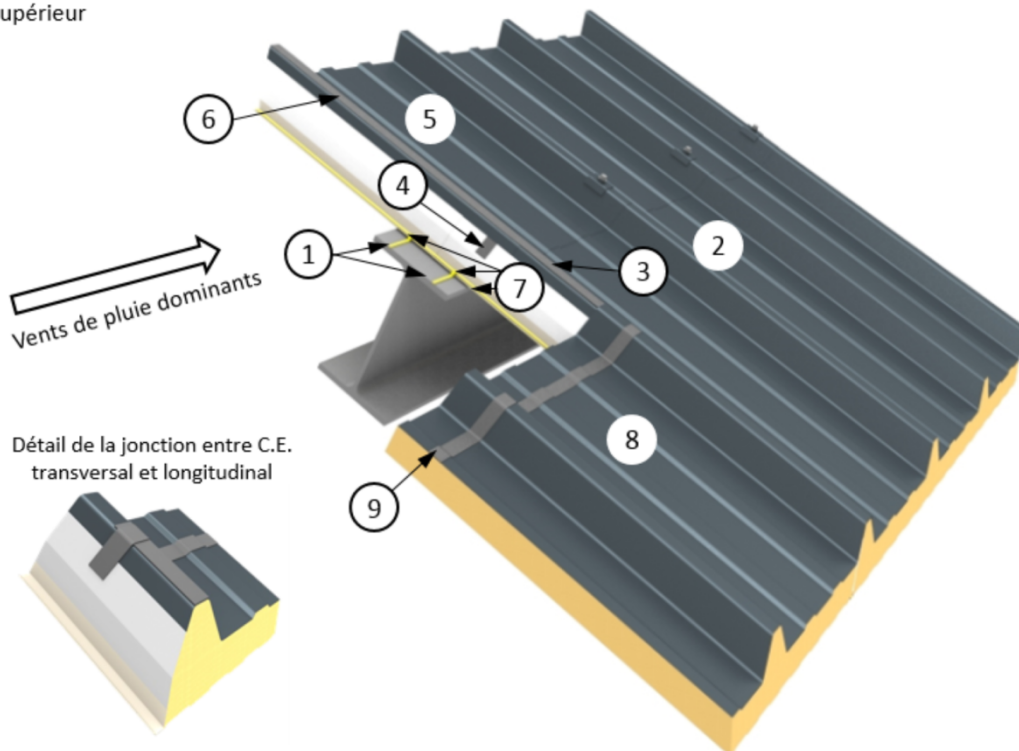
Détail sur appui – Joints sur appui au droit d'un recouvrement transversal de panneaux avec Complément d'Etanchéité (C.E.) transversal et longitudinal - locaux climatisés (cf. §2.4.4)
